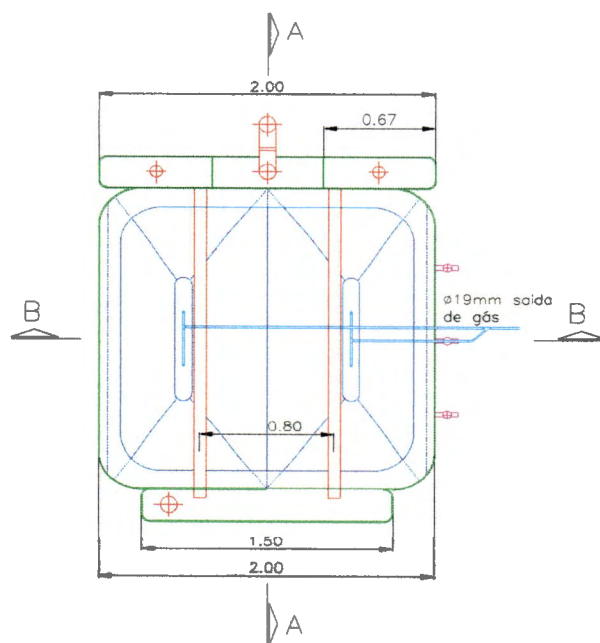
Planta Alta do reator UASB (cotas em metros)
